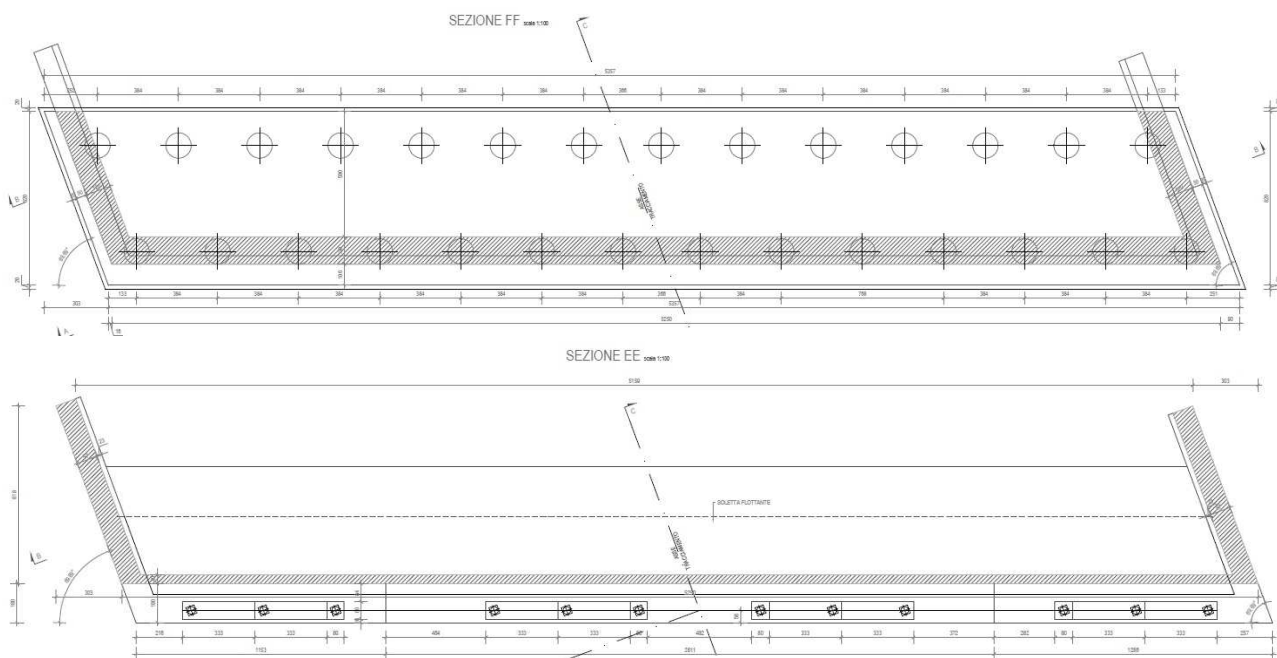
Pianta carpenteria - Spalla tipo
